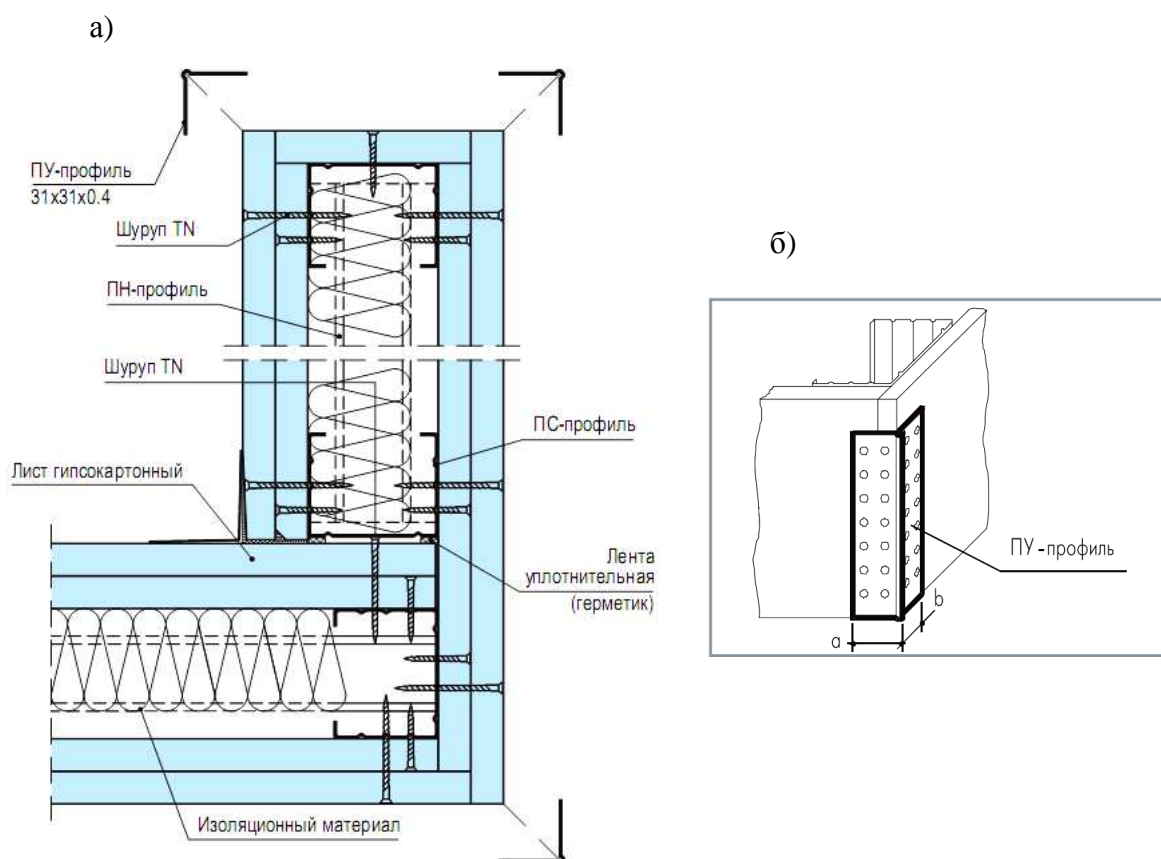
Наружный угол перегородки из гипсокартонных или гипсоволокнистых листов (а) и схема установки ПУ-профиля на наружный угол перегородки (б)
